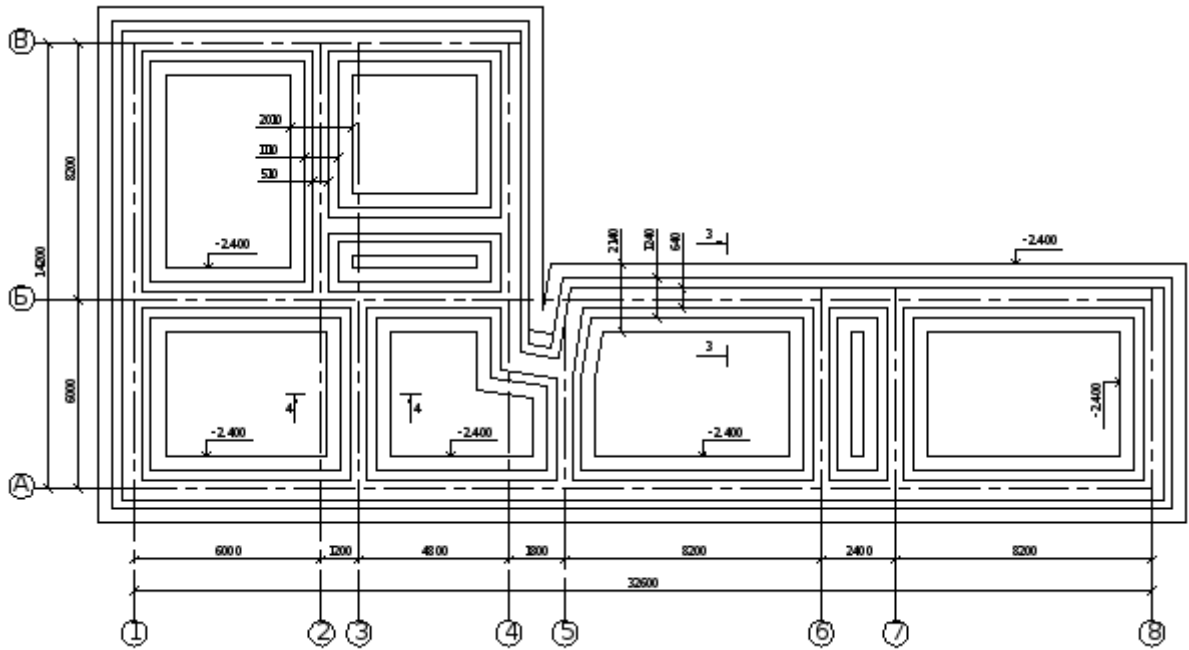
Фрагмент плана усиления фундамента с омоноличиванием уступа.
